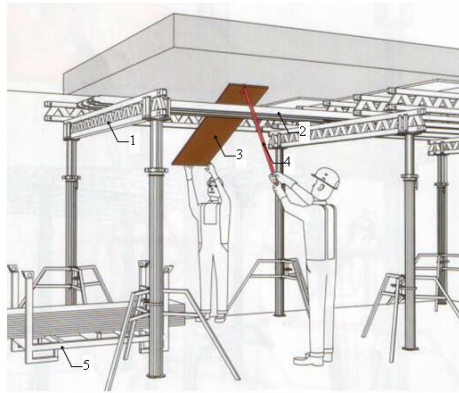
Демонтаж фанери: 1 - поздовжня балка; 2 - поперечна балка зкантована «набік», 3 - лист фанери, що демонтується; 4 - поздовжня балка; 5 - контейнер для складування фанери
